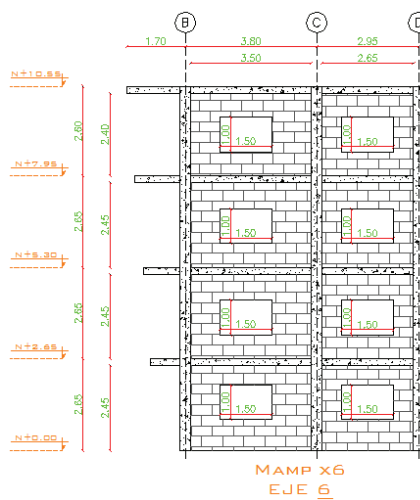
MAMPOSTERÍA ENCHAPADA EJE 6.
